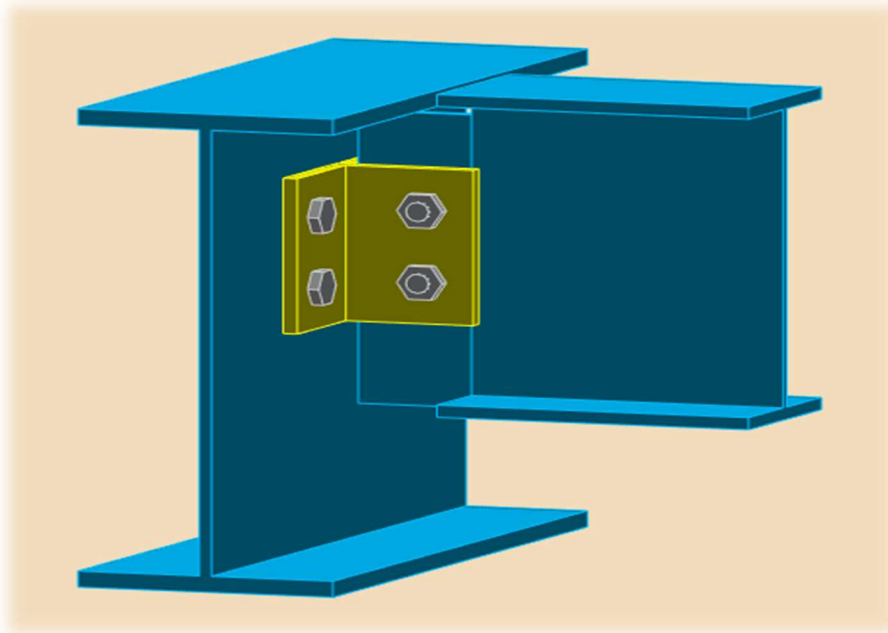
3D d'assemblage poutre-solive (IPE400-IPE270)
